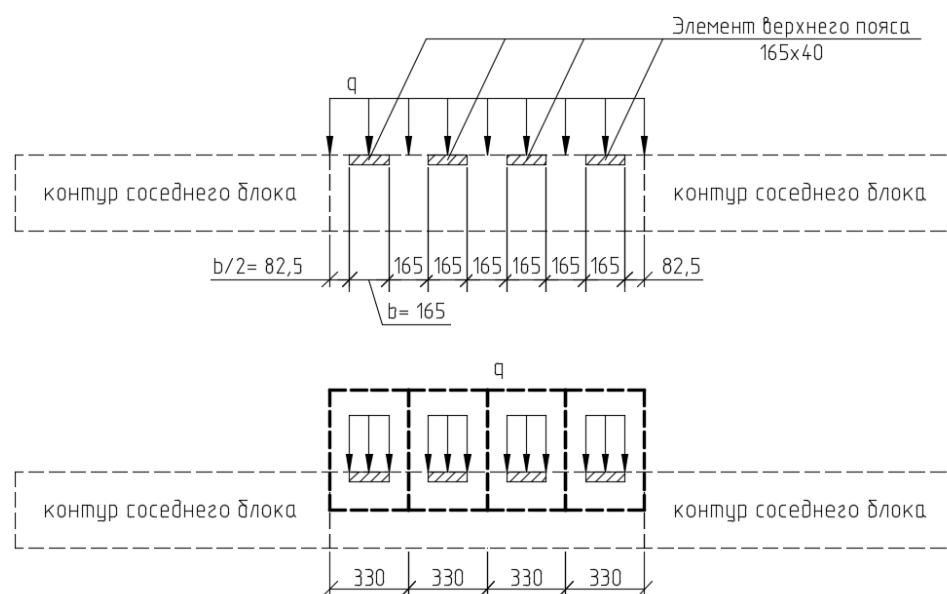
Перераспределение нагрузки на верхний пояс
